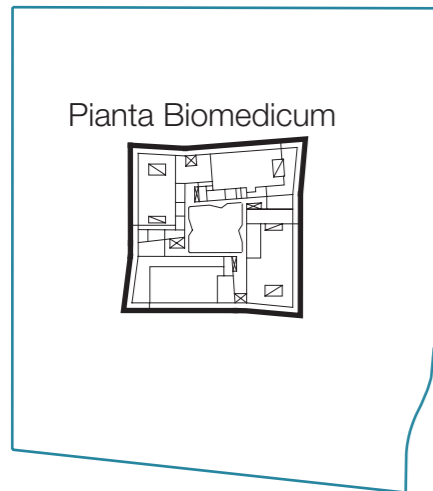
Planimetrie dei vari piani. Elaborato ZA, 2022.
